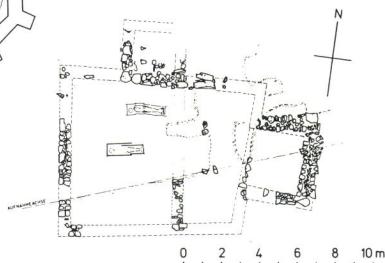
Ufenau. St. Martinskapelle. Grundriss mit den nördlichen Teilen des Grundrisses der ersten St. Martinskirche (um 700) mit späteren Um- und Anbauten: Vorhalle, Stützmauern (?) und Chorverstärkung. Nach B. Frei bzw. P. Ziegler.
